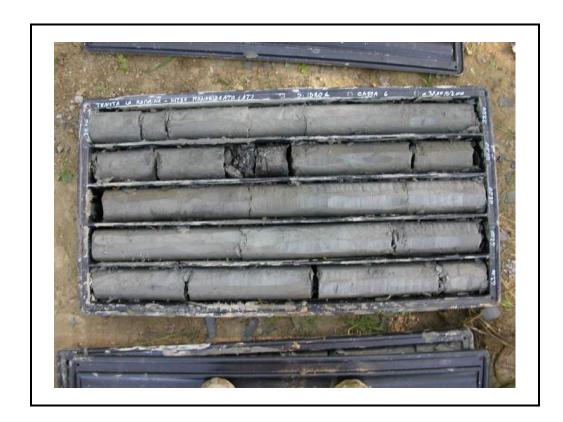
Sondaggio 1 - cassa 6 - da 38.00 m a 43.00 m.
